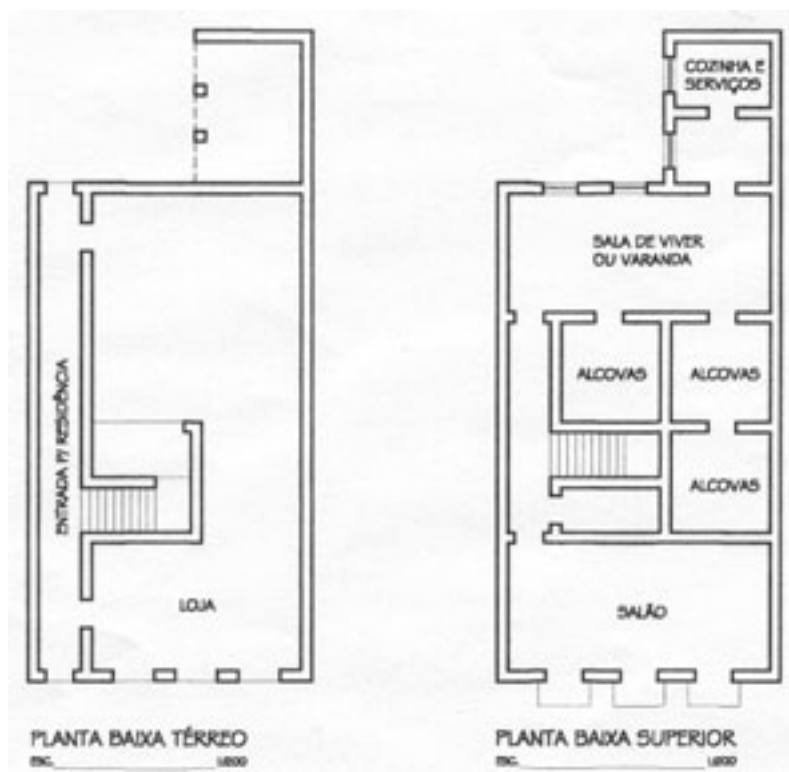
PLANTAS DO SOBRADO TÍPICO COLONIAL BRASILEIRO.
